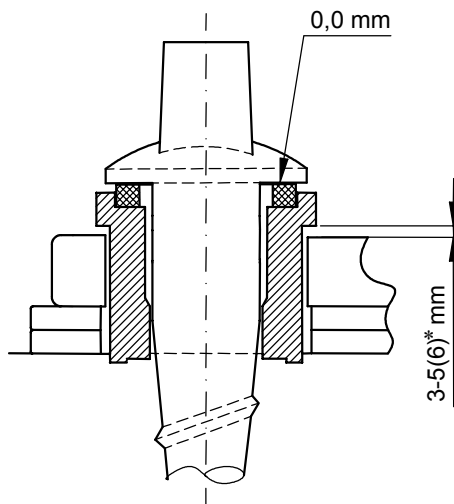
+ Tab. 3 Vrtule R 2 s plastovými distančními kroužky PDK 1 na betonových pražcích
